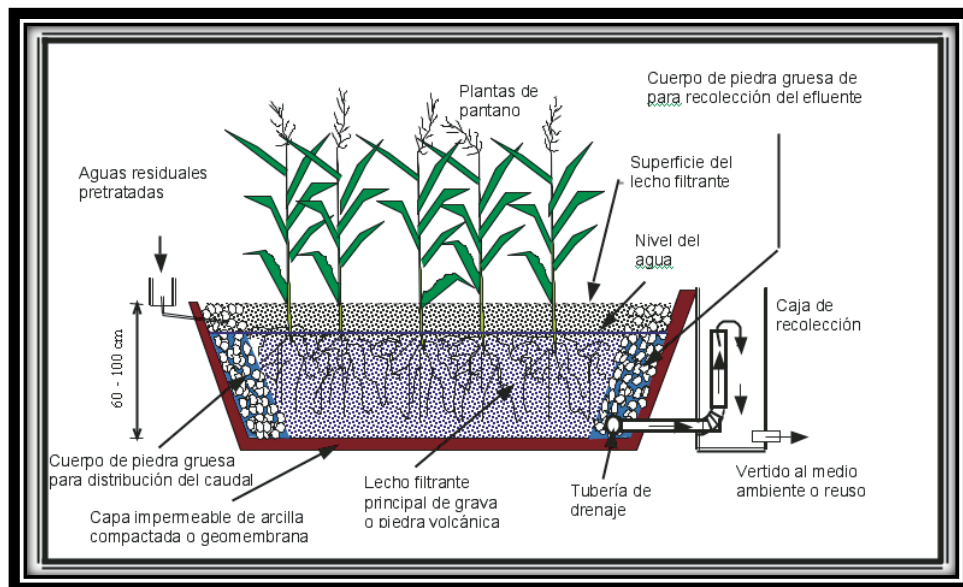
Sección longitudinal de un biofiltro de flujo horizontal
